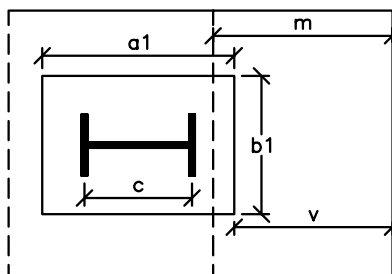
Vuelo de cálculo en una zapata con pilar metálico.
